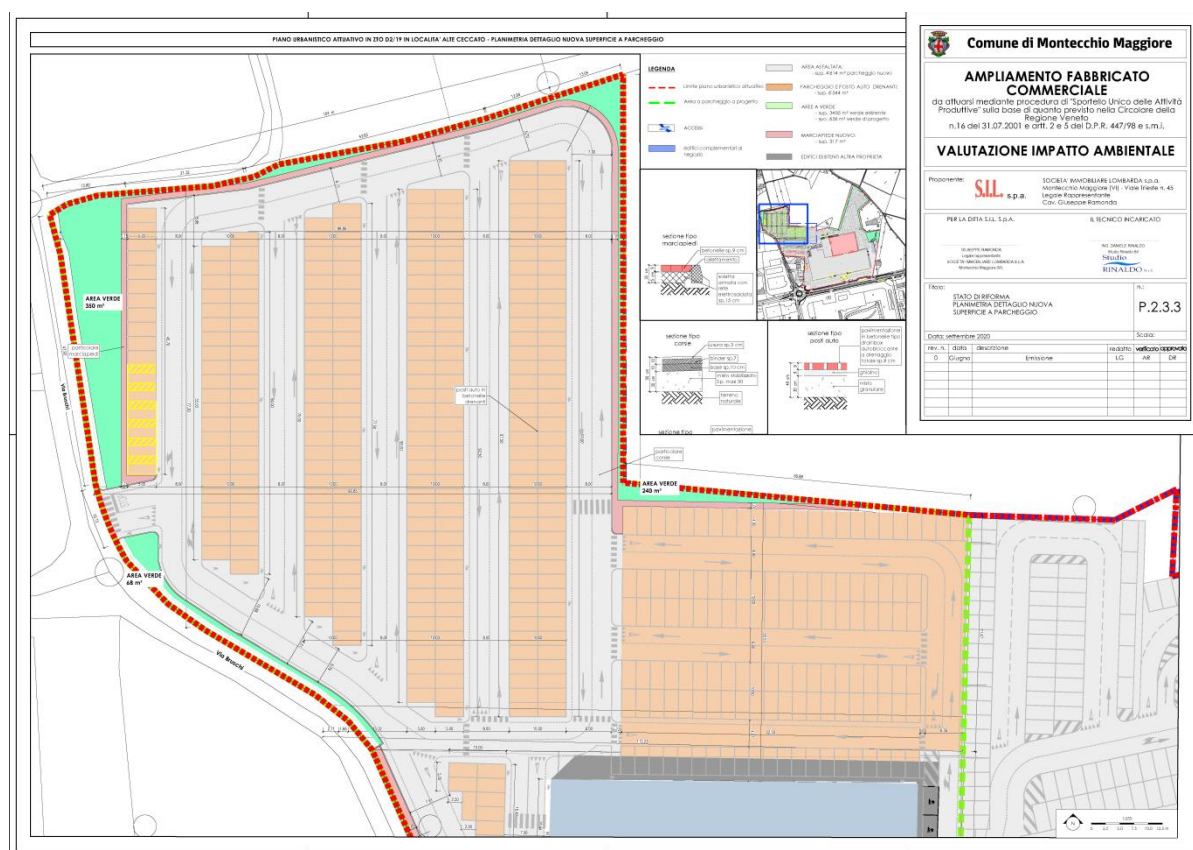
tavola P.2.3.3 Sistemazione esterna stato di riforma planimetria dettaglio
